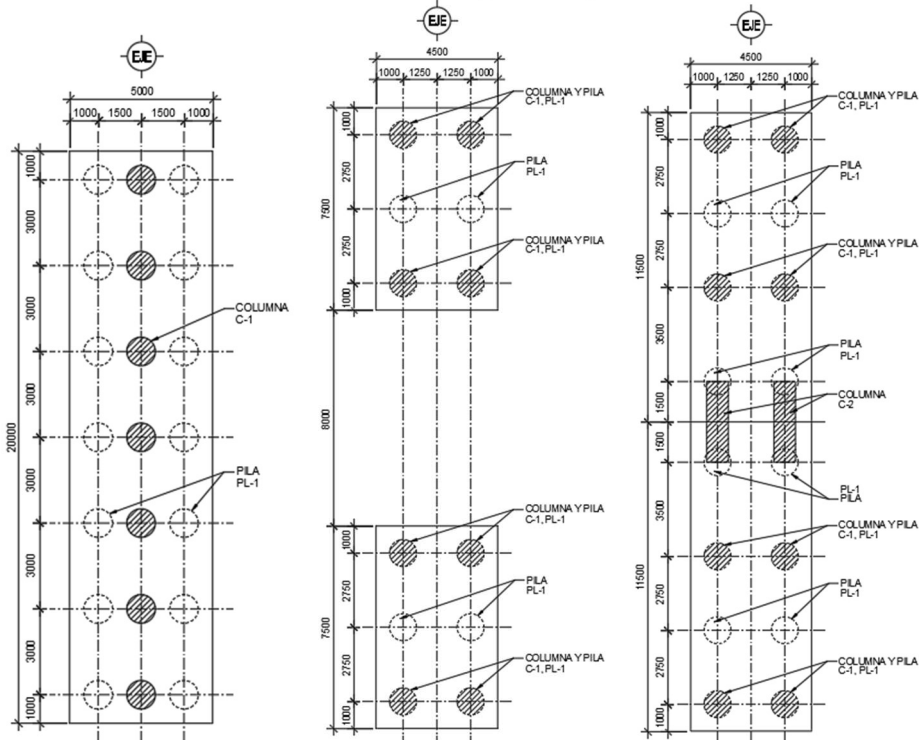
Vista en planta de la cimentación los soportes S-1, S-2 y S-4
